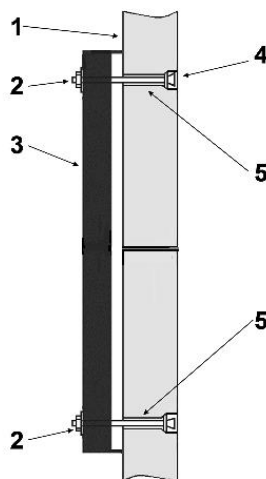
Крепление кронштейнов ККП-60 на стене колодца ККСр-2,5:
